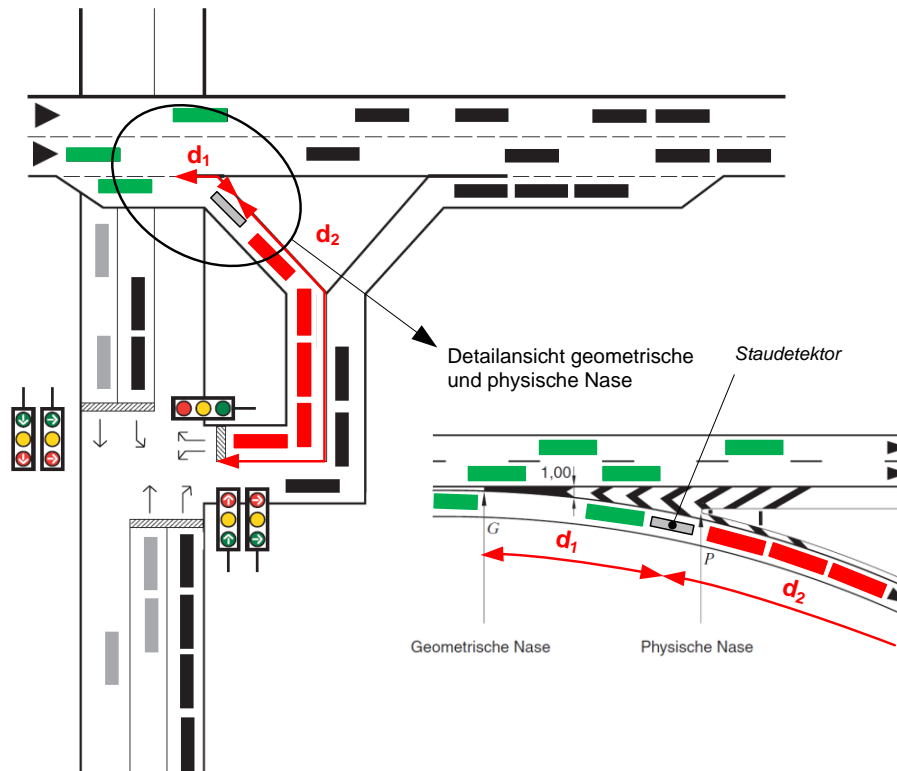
Stauräume auf der Ausfahrtsrampe und Positionierung Staudetektoren.
